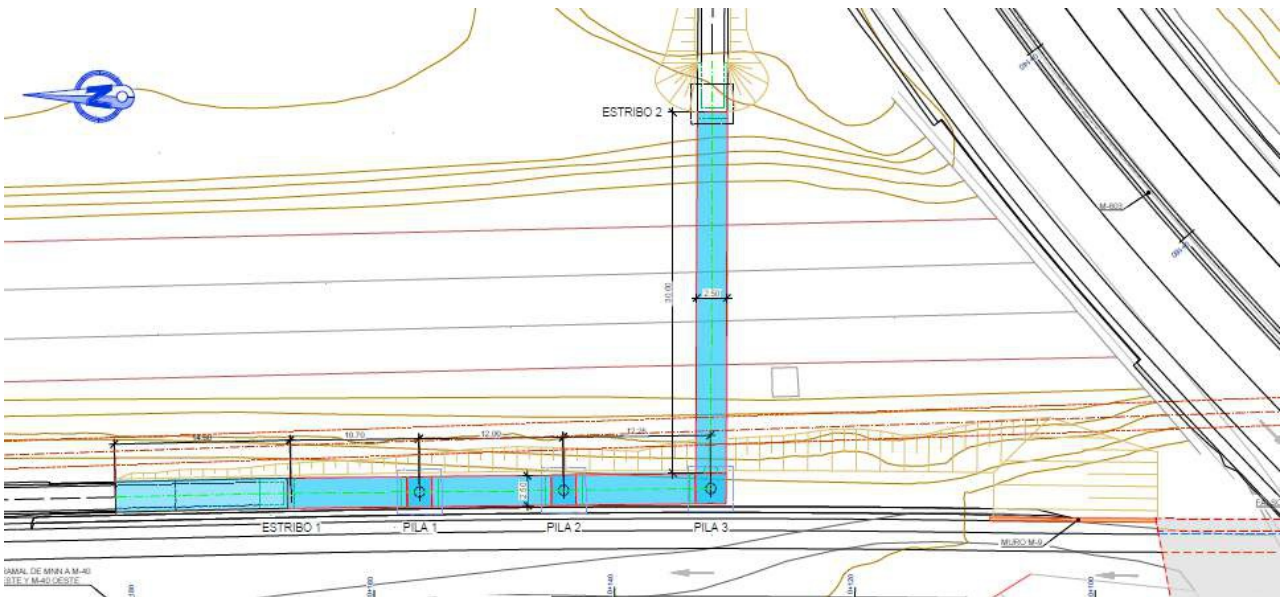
Encaje en planta alternativas 2A y 2B. Pasarela P-3
